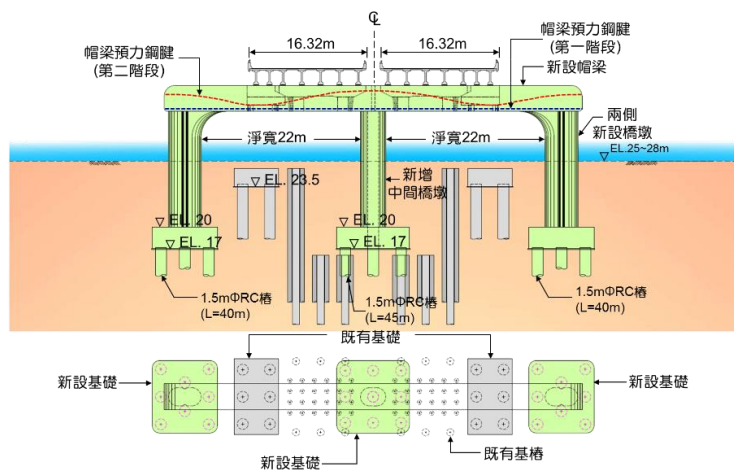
中沙大橋改建工法施工步驟示意圖(7/7)
